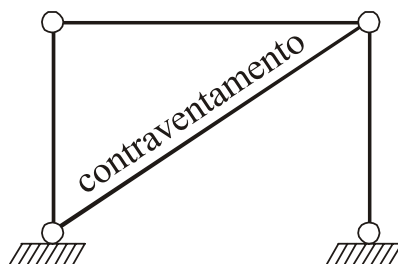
Pórtico com ligações articuladas e com contraventamento.
